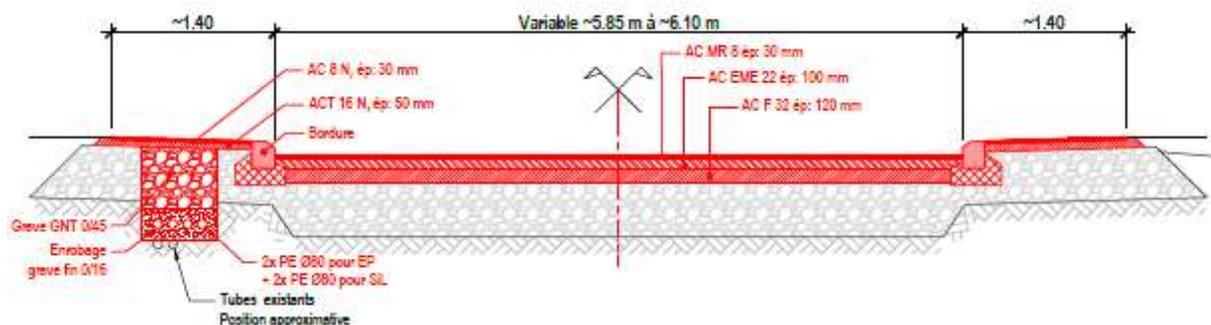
Exemple de coupe type sur le secteur de la Rte du Village
